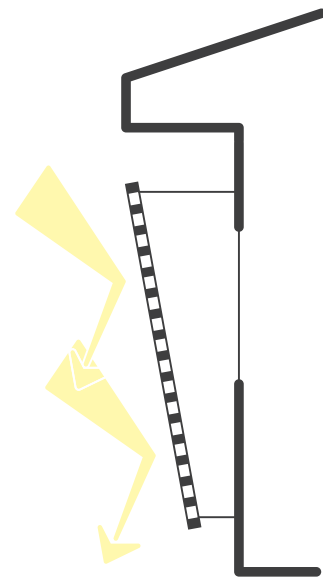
Diagramas de protección solar empleado en la fachada oeste de la adaptación de la vivienda. Creado por el autor.
